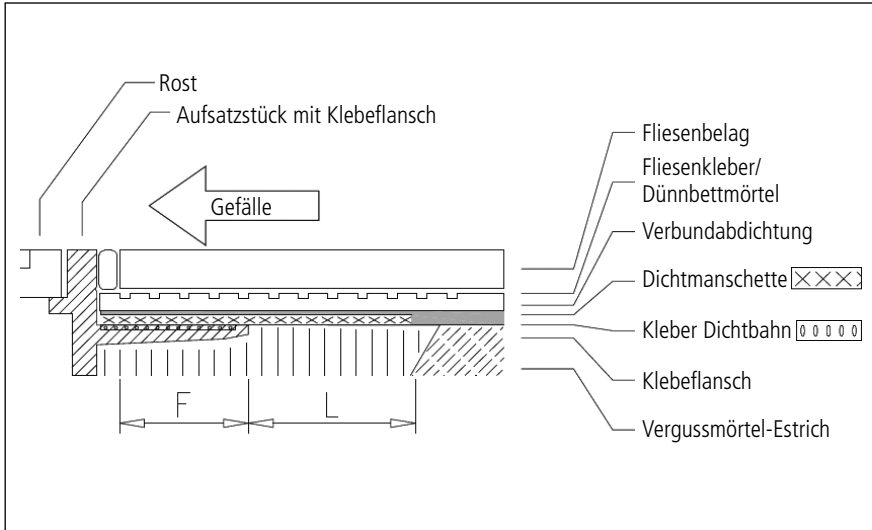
■ Anschluss eines Ablaufs an eine Verbundabdichtung mit Klebeflansch – Detail [26]
